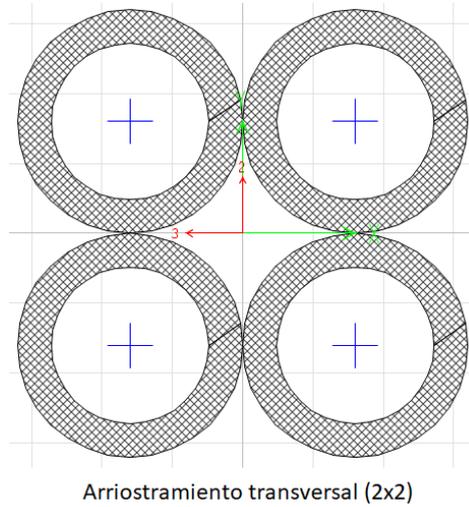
Sección transversal de arriostramiento transversal. Fuente: Propia
